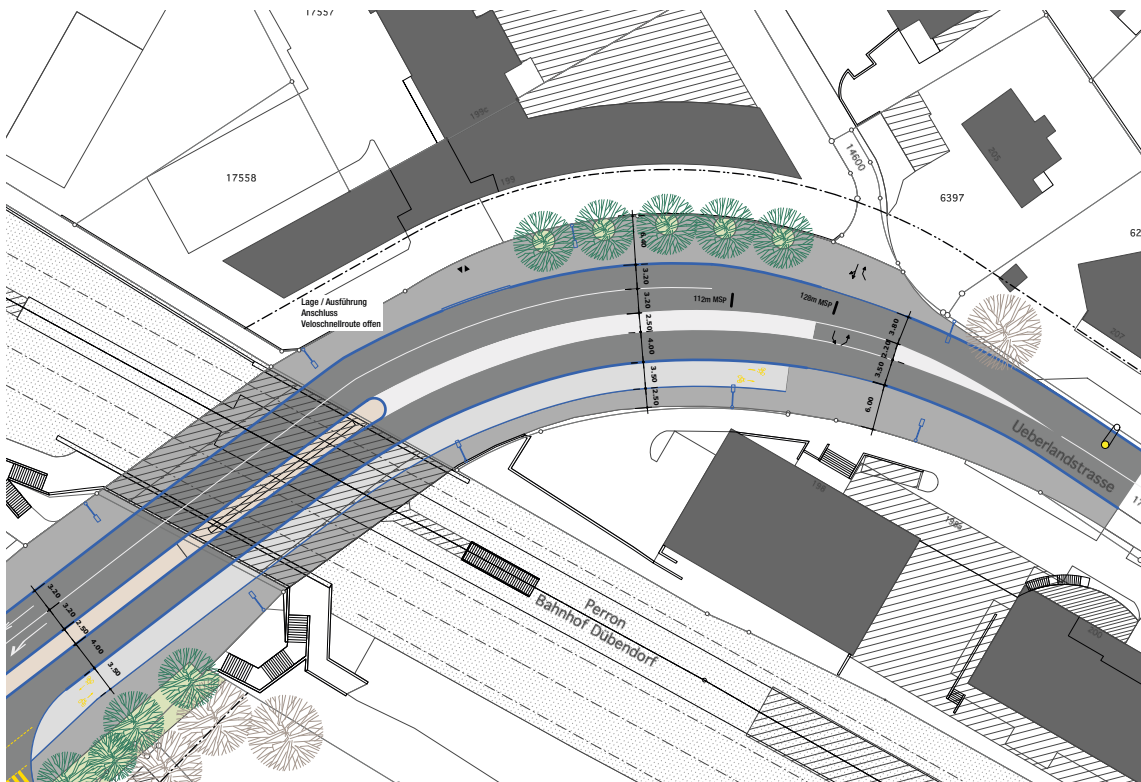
Ausschnitt Situationsplan: Bereich Bahnunterführung Nord 1:1'000
